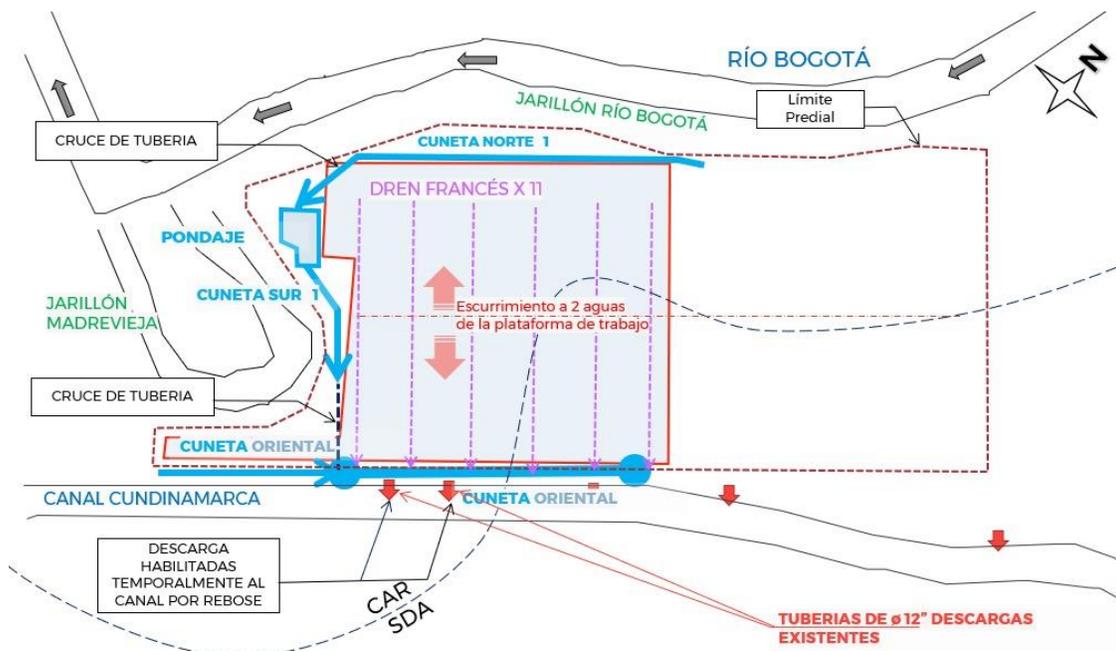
Planta general de drenaje de la plataforma en la etapa de construcción
